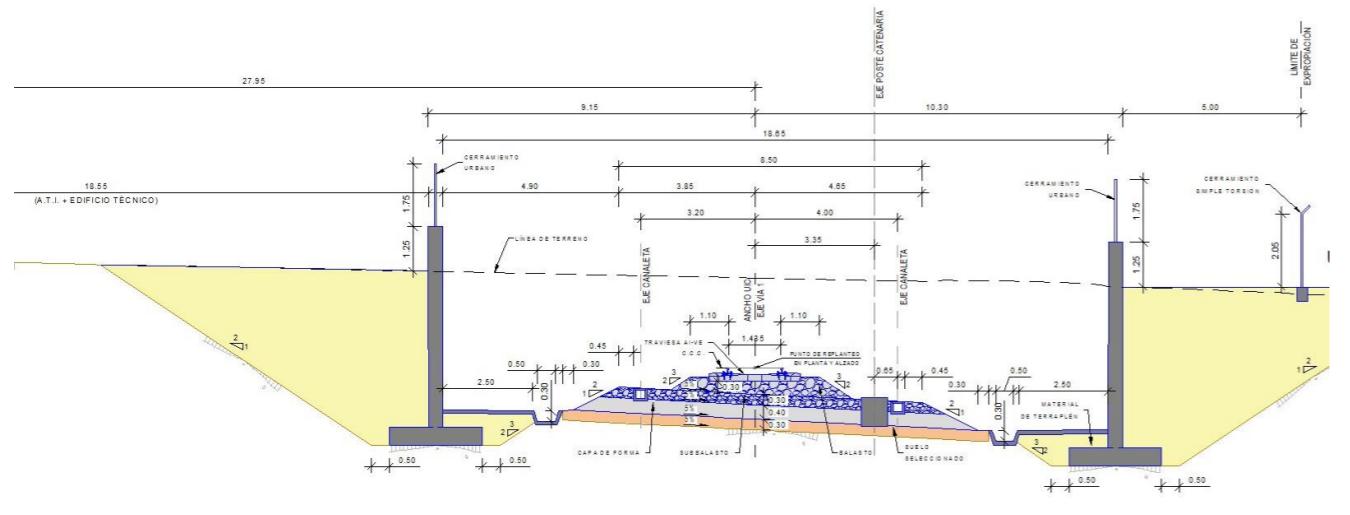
Sección Tipo con muros a ambos lados. Alternativa B
